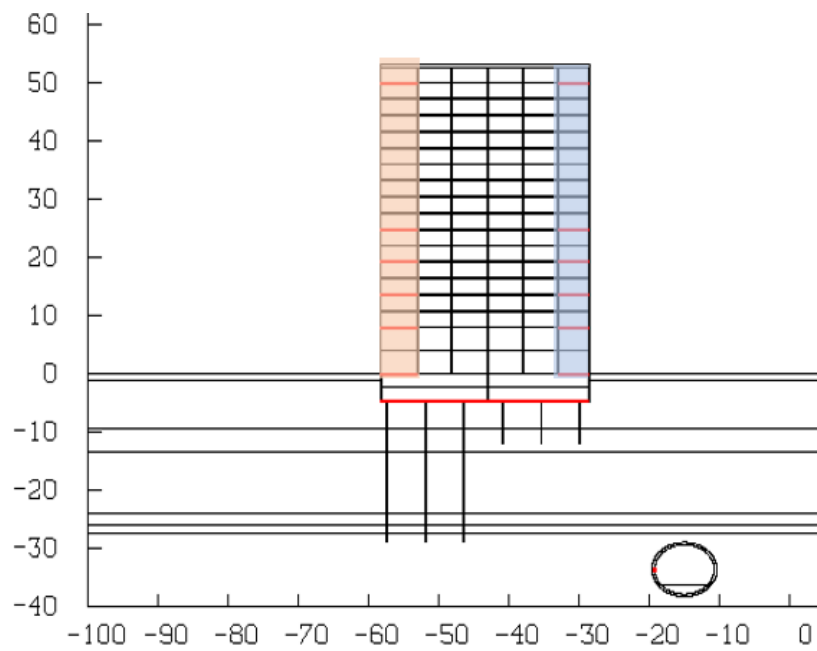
Bâtiment Arrière : 6 murs de 16cm pour 30 m (taux : 3.20%)
